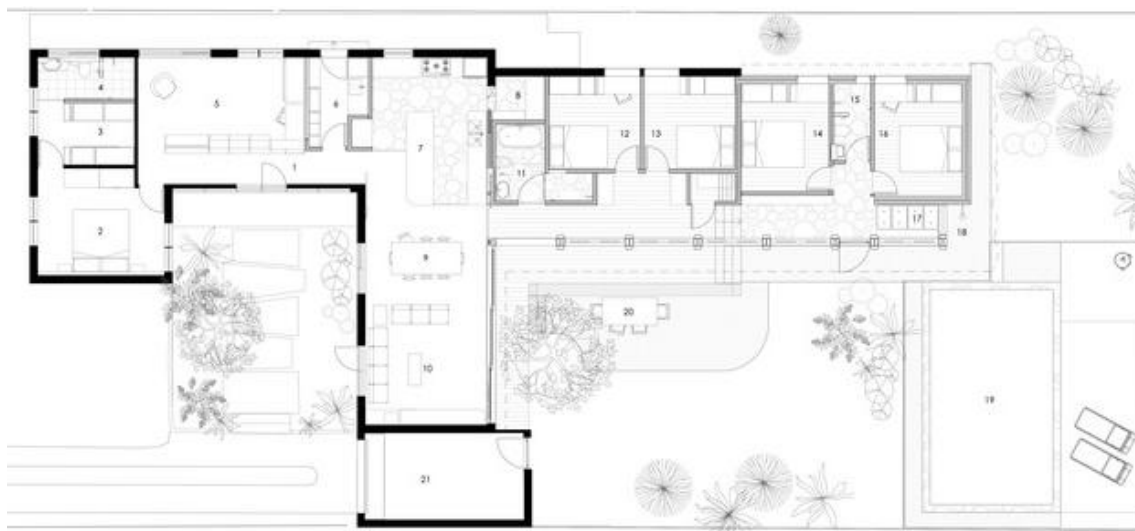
Planta Proposta, Casa PONY. Fonte: Site WOWOWA , Autores: WOWOWA
